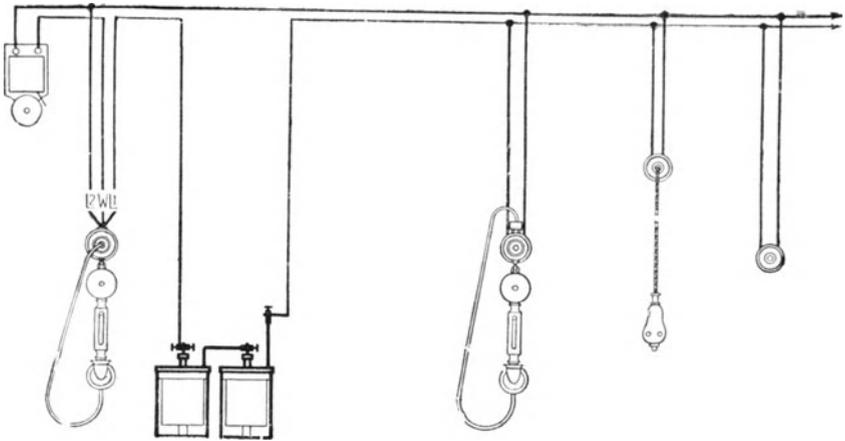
Haustelephonanlage mit Verwendung der Klingelleitung.
